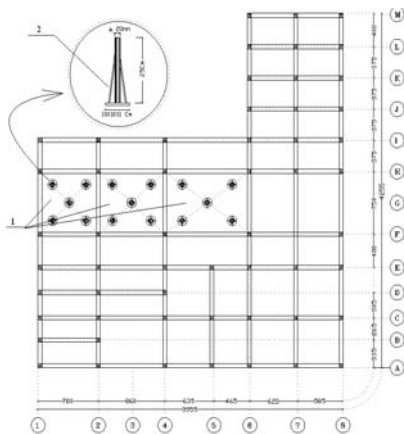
Опалубочные чертежи перекрытия, на котором проведены испытания (плиты 1, 2, 3)
